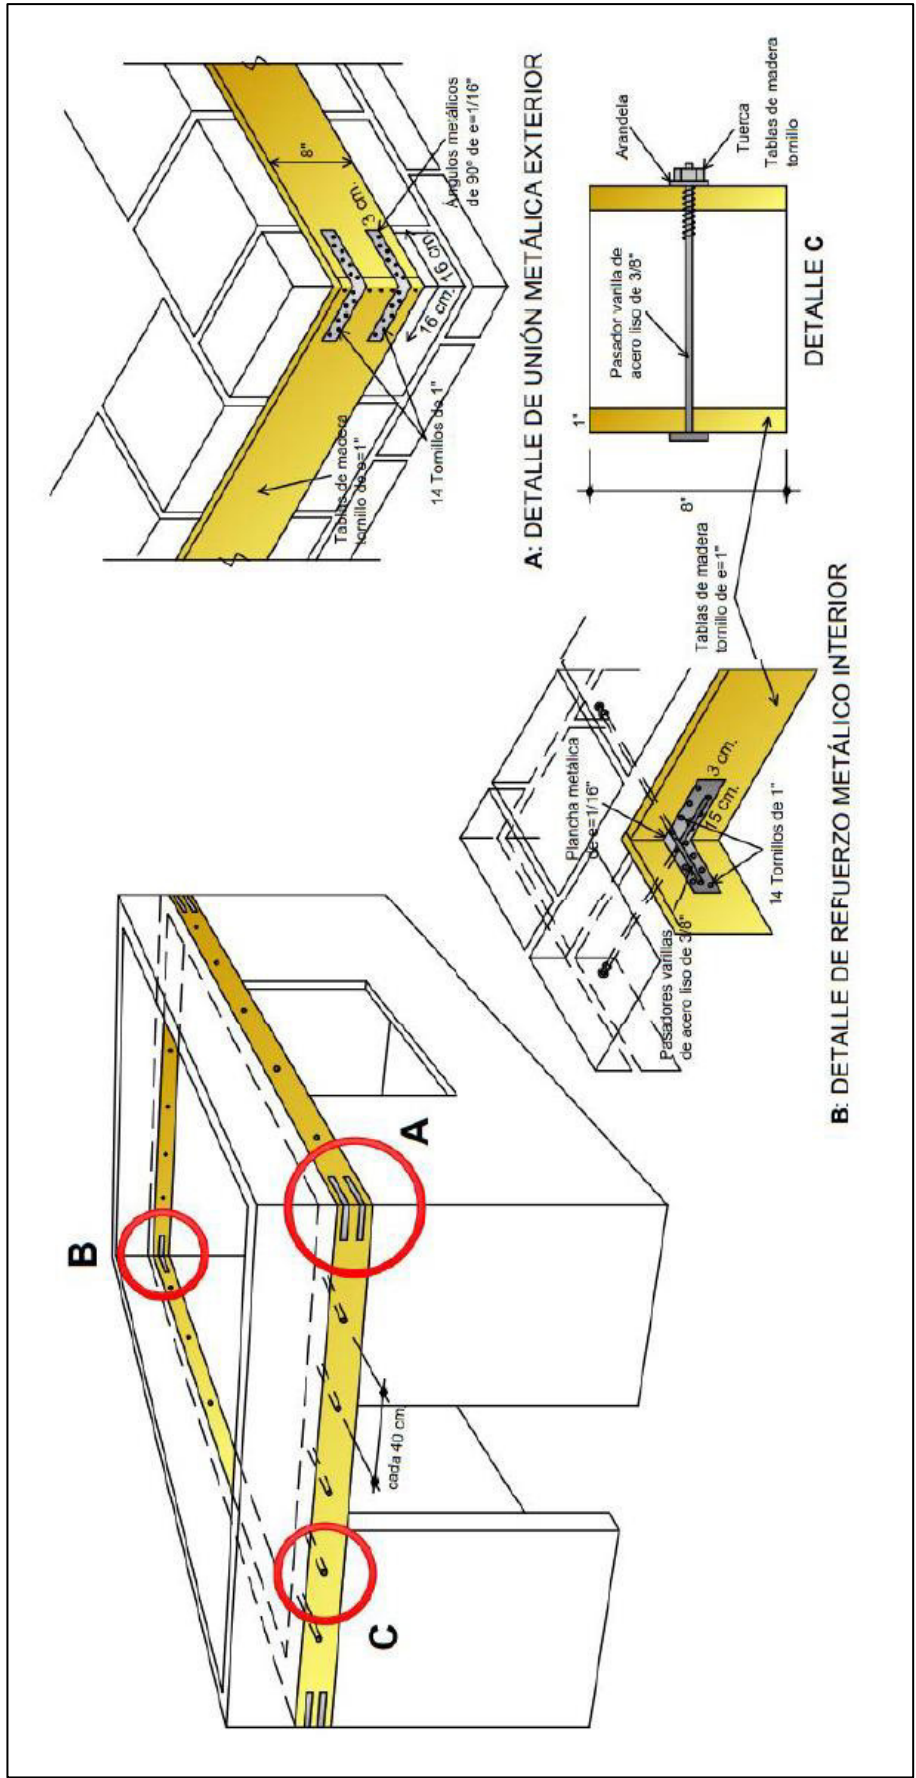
Alternativa de reforzamiento para viviendas de adobe. (Kuroiwa J. 2002)
